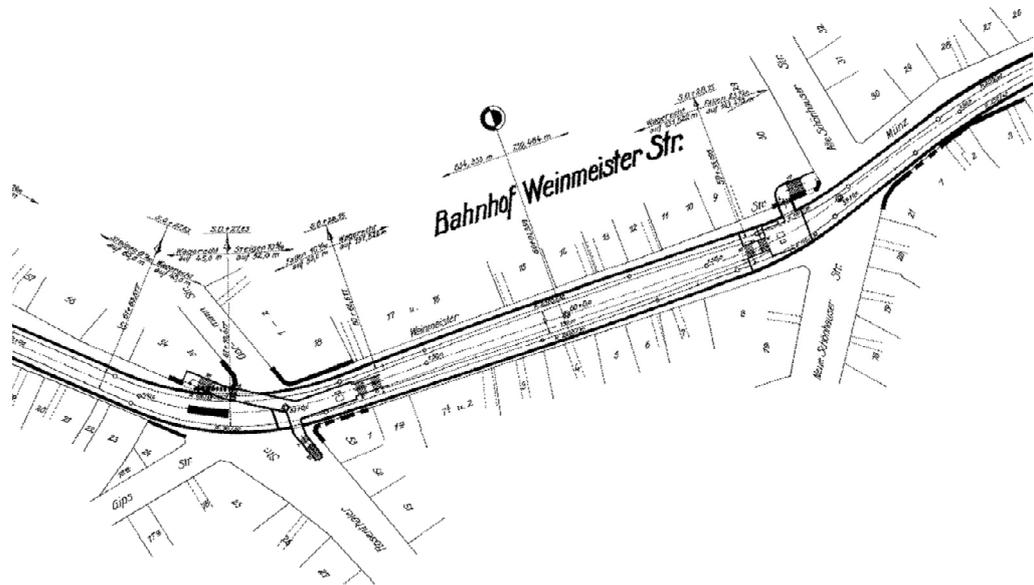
Straßenebene Grundriss aus der Entstehungszeit
